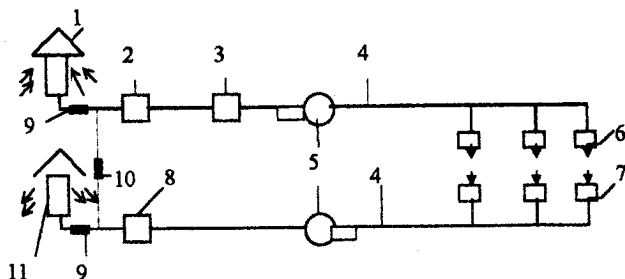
Схема припливно-витяжної механічної вентиляції
